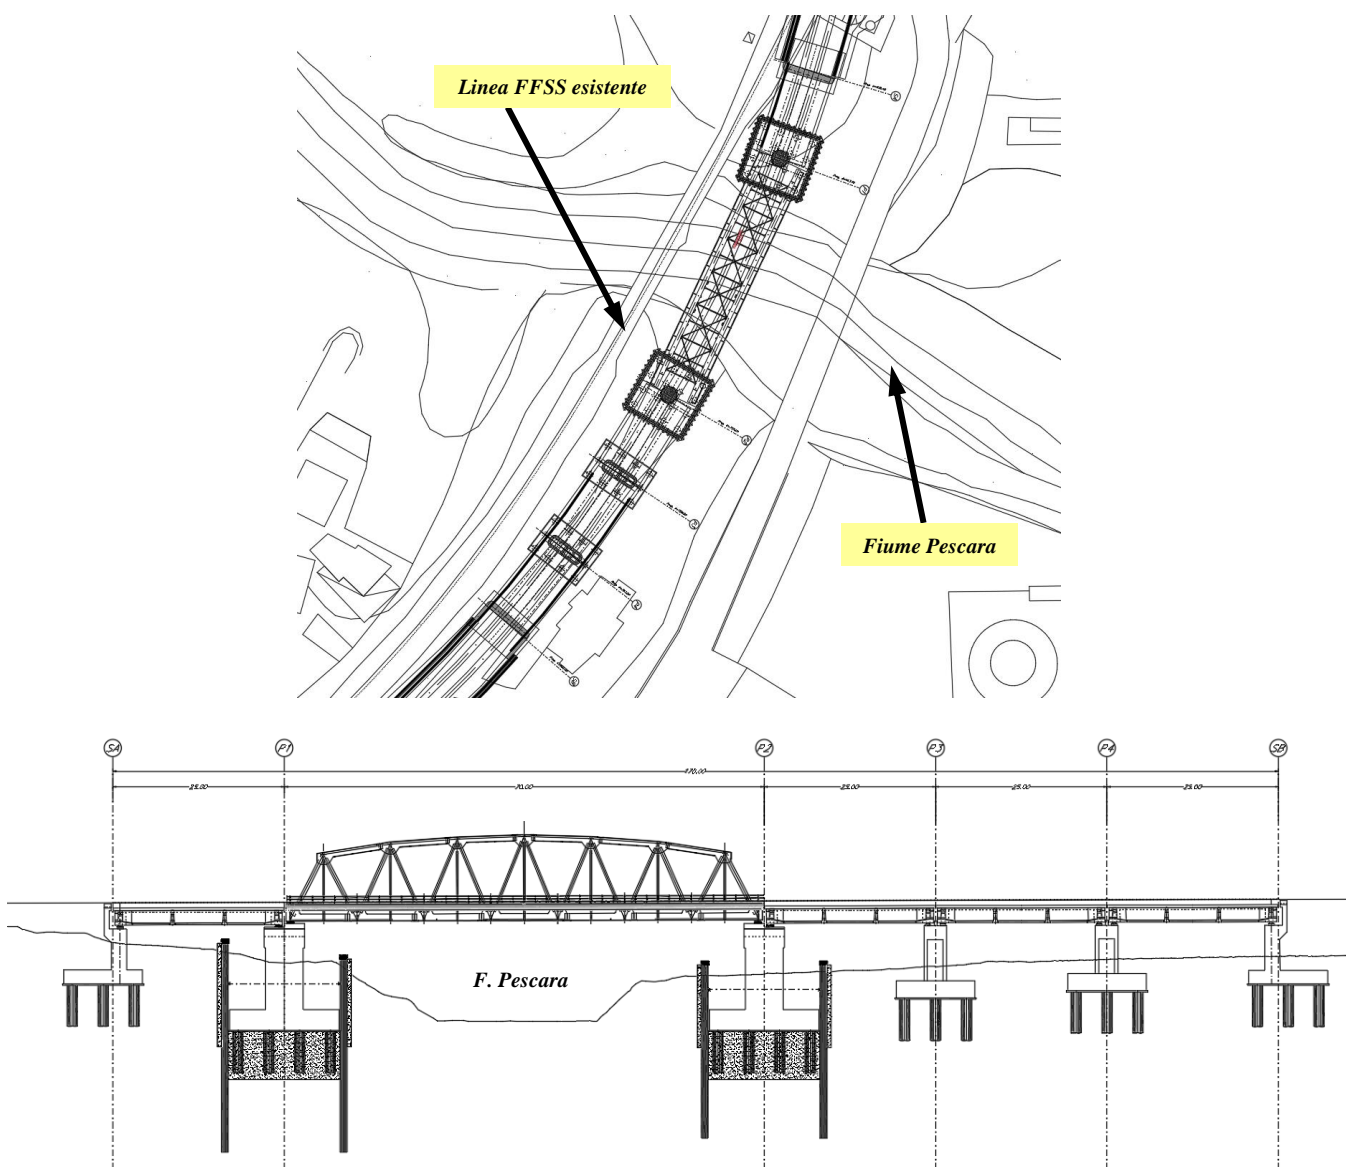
Fiume Pescara: pianta (in alto) e prospetto lato monte (in basso) del nuovo viadotto VI23.
